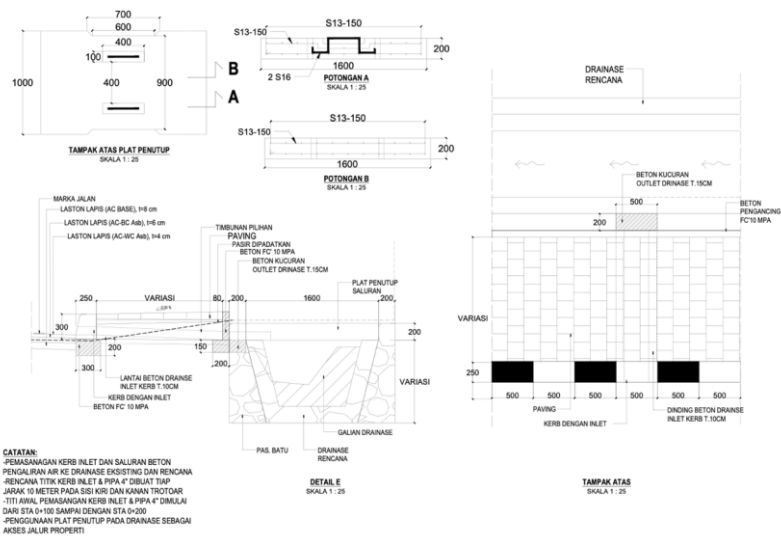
Tipikal potongan melintang penanganan badan jalan, drainase, dan trotoar
